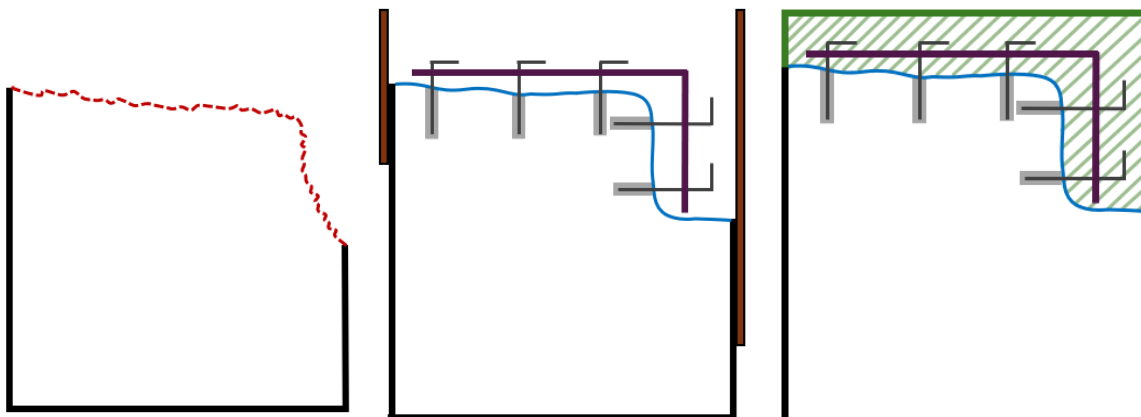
Principe de reprise des ailes du barrage 2, état du parement dégradé (à gauche), principe de coffrage et ferrailage (au centre) et coulage du béton (à droite), voir légende Figure 9.
